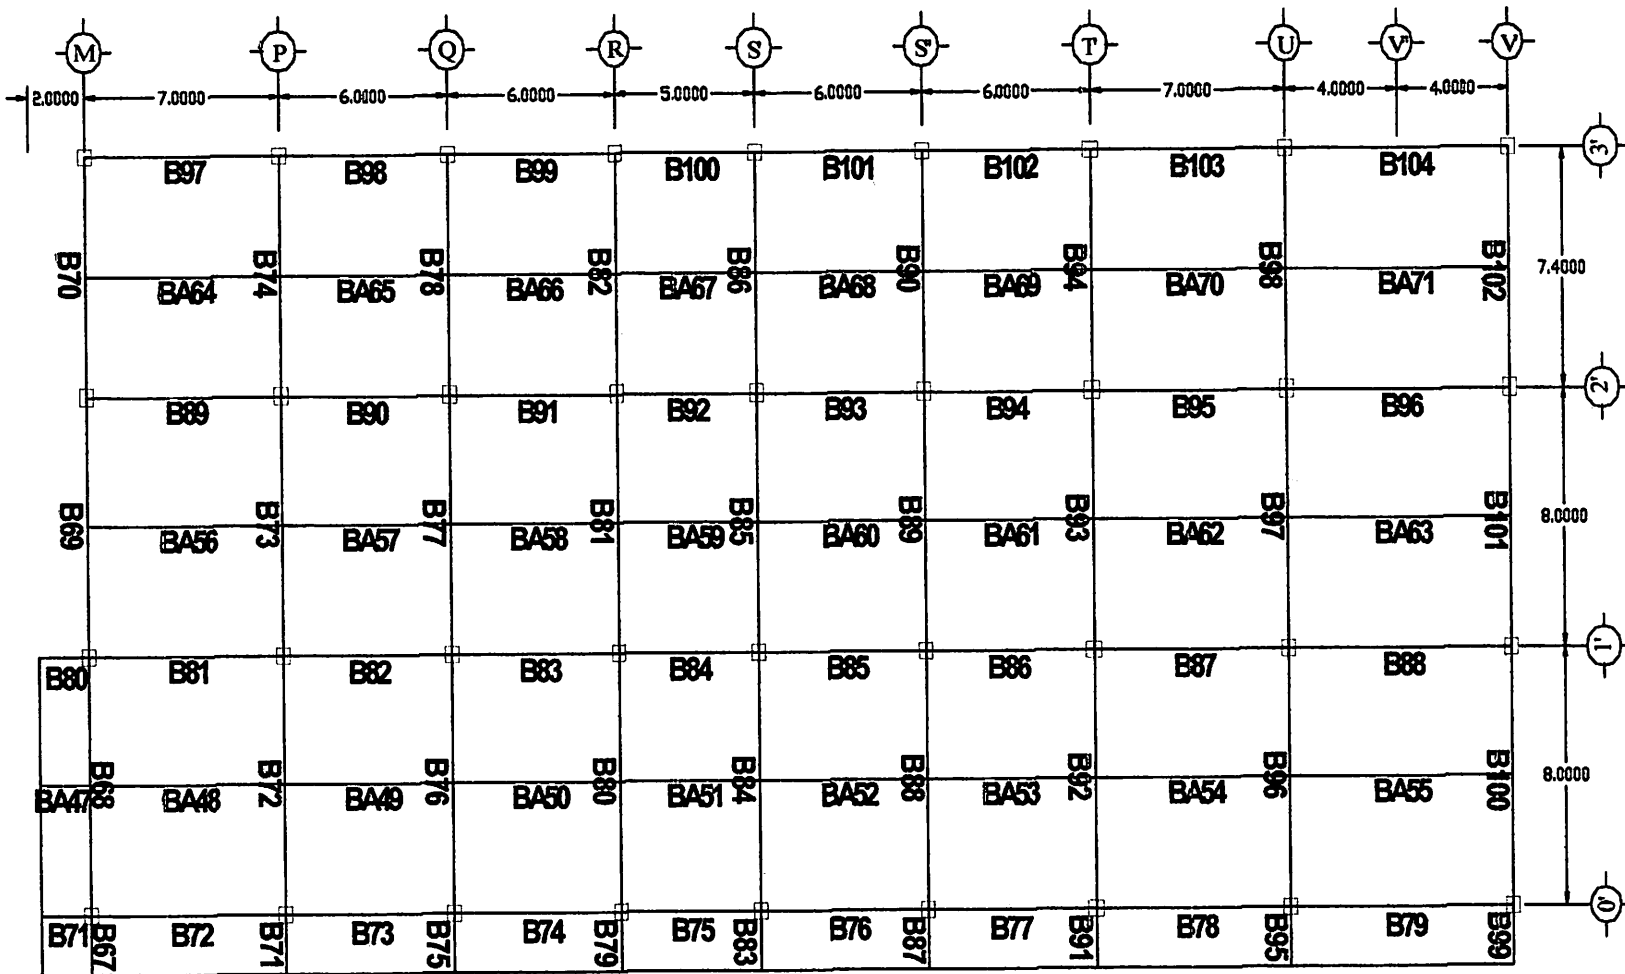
Denah Balok Lantai 1A Per tokoan
